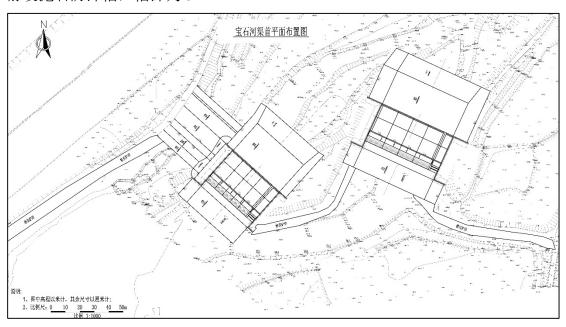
宝石河东泉屯生态连通改造工程平面布置
